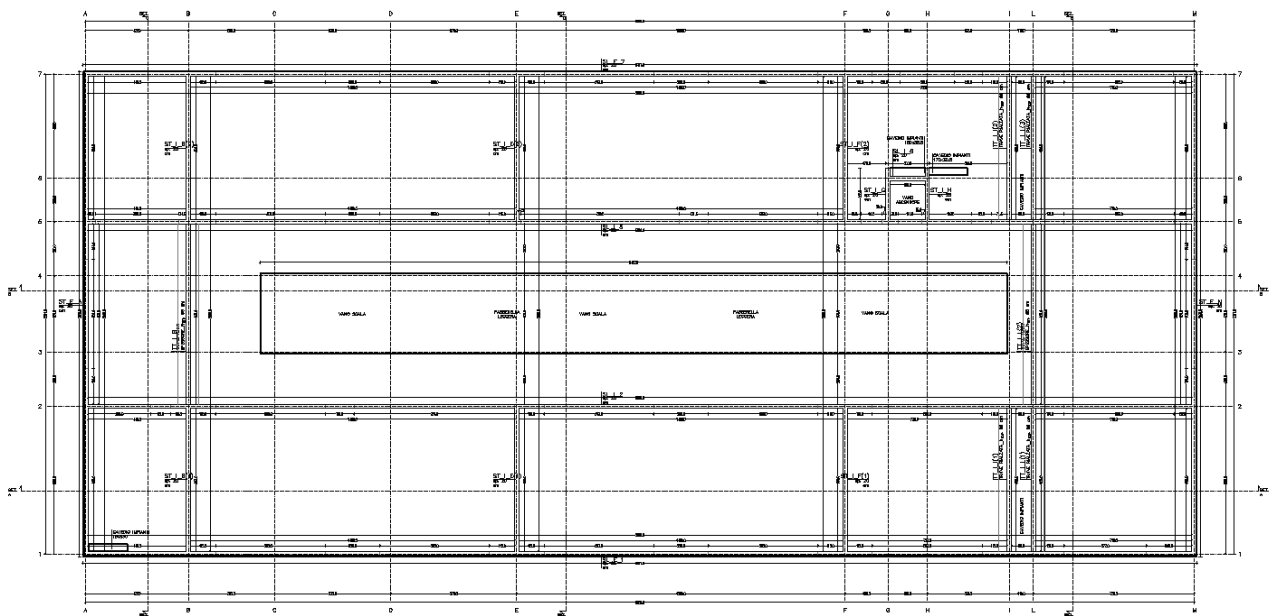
Pianta setti copertura scuola: strutture in progetto
